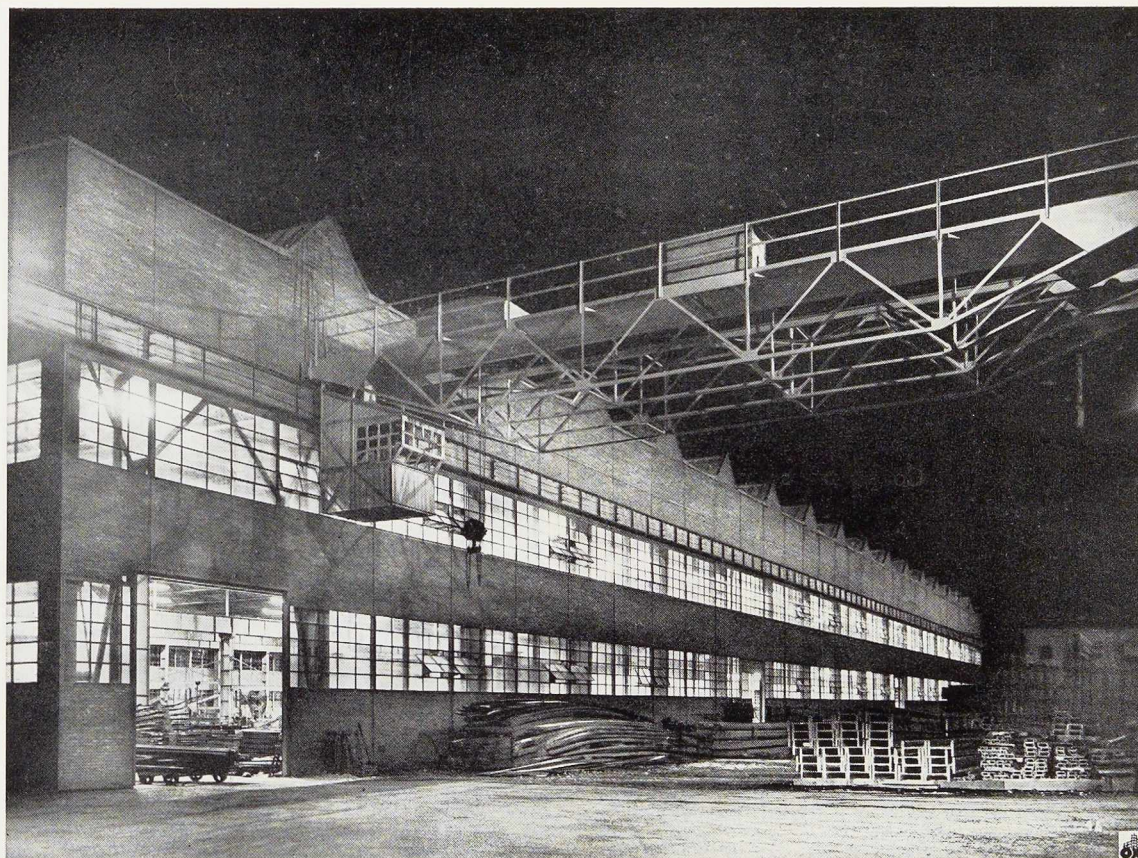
Vue d'ensemble de la nouvelle usine de la Société Bossi (prise la nuit).
